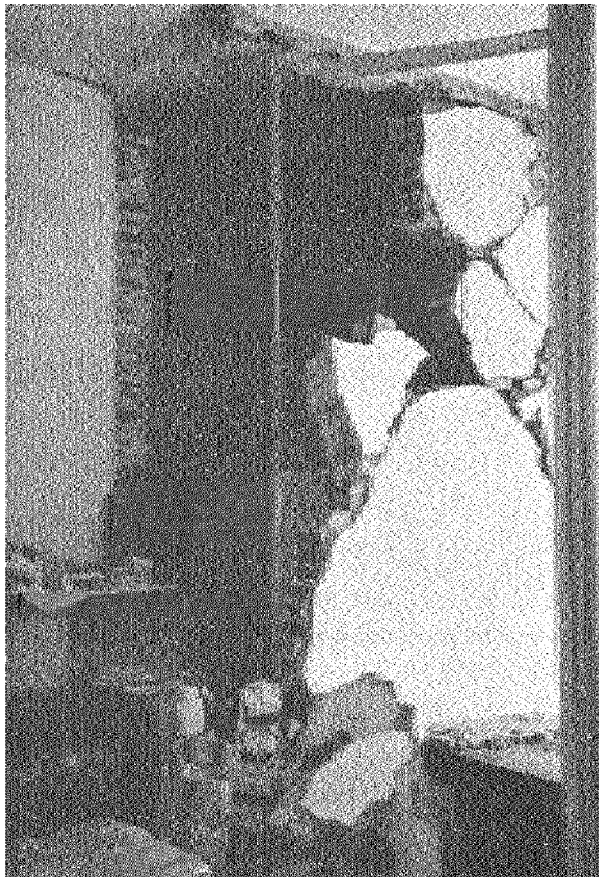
Muro de mampostería interior con nivel de daño V.
